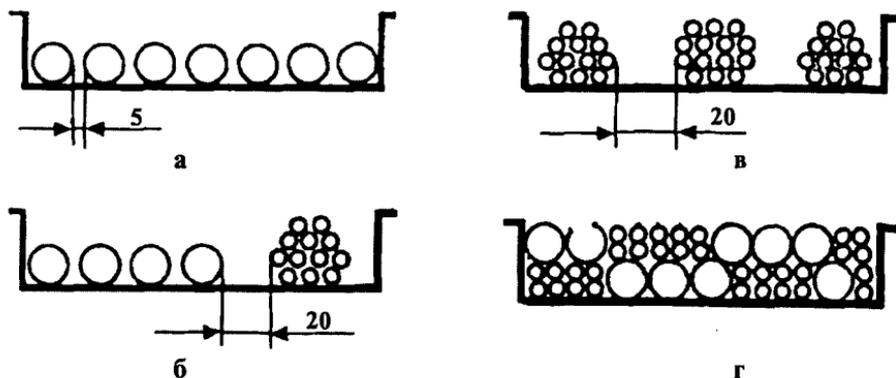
Способы прокладки проводов и кабелей на лотках:
